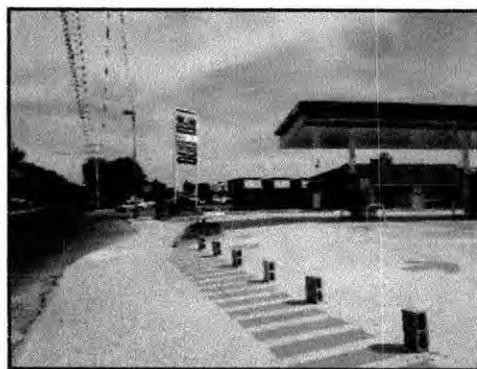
Colindancia oriente de la estación de servicio
